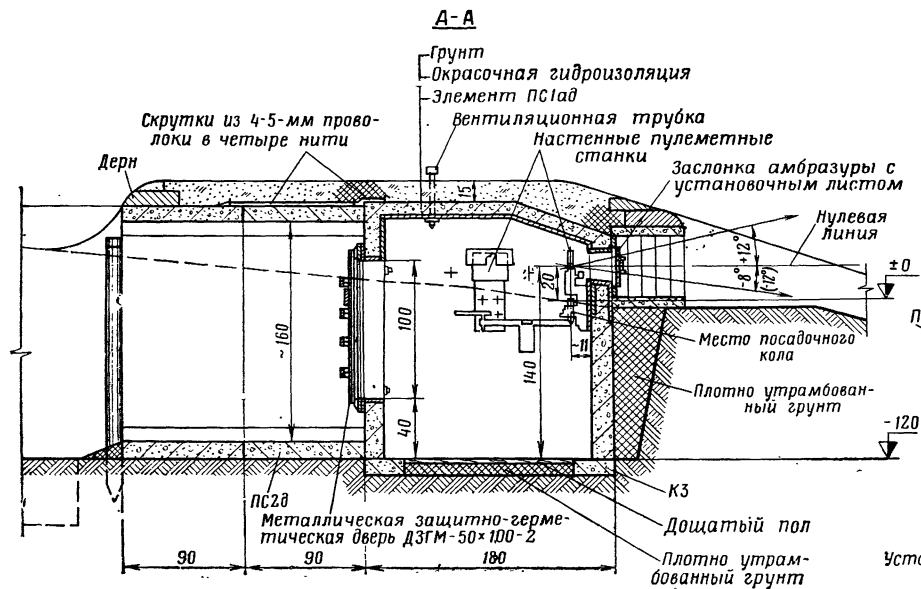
Сборное железобетонное пулеметное сооружение СПС-2М (общий вид)
